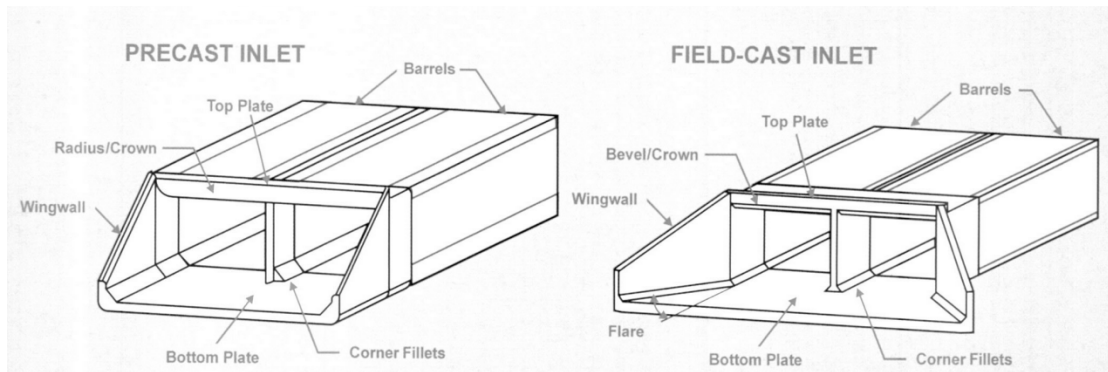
Alcantarillas tipo cajón de concreto, de barril doble con alero recto y en ángulo
